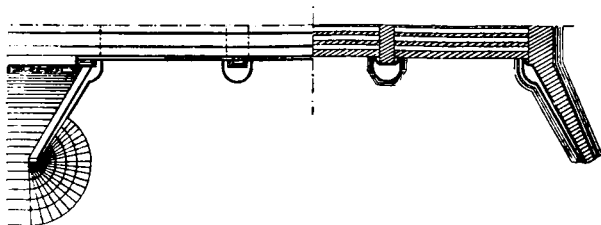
Планъ устоя съ откосными крыльями у того же моста.
